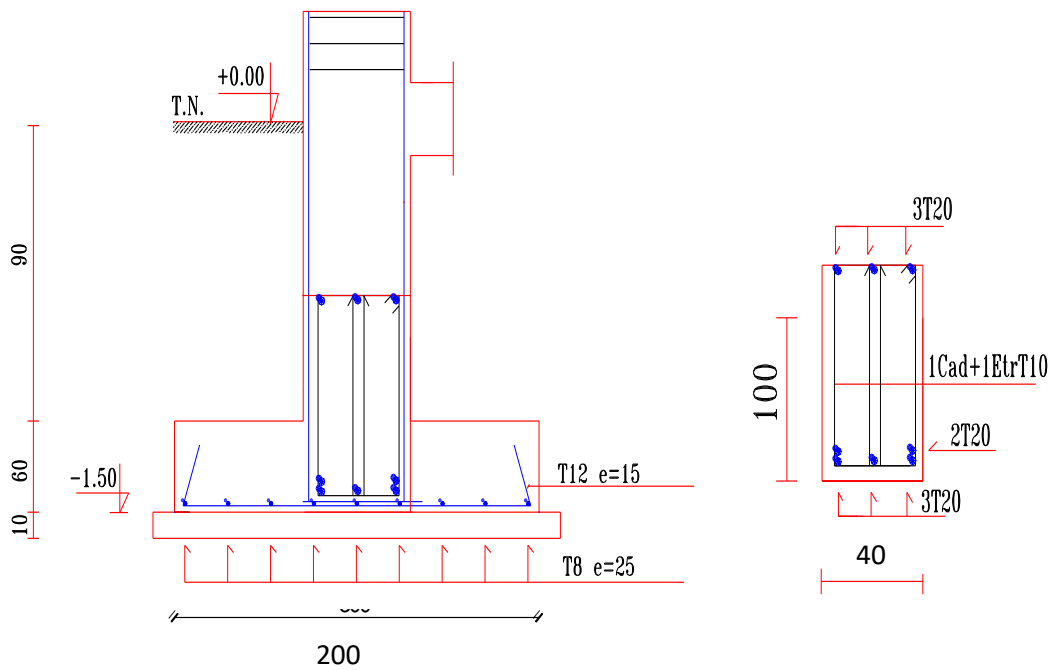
Schéma de ferrailage des semelles filantes travier Y-Y
